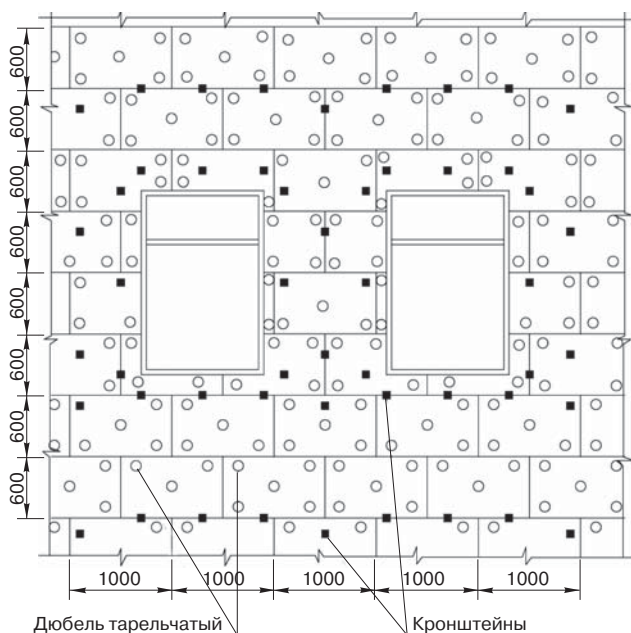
Схема установки металлических кронштейнов и дюбелей с металлическим сердечником на фрагменте стены для вентилируемого фасада
